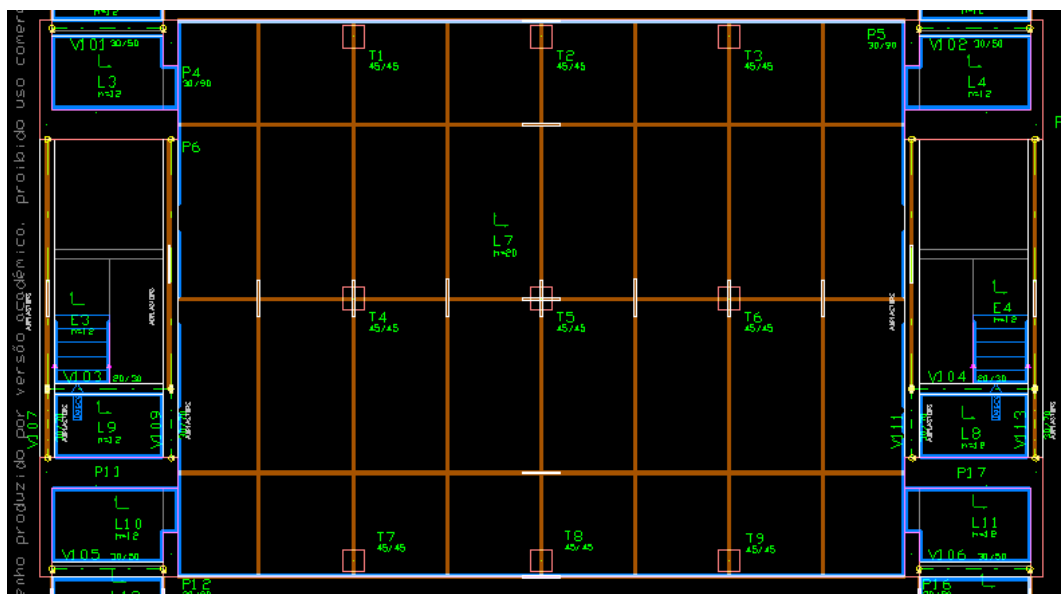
Cargas de alvenaria na laje principal do pavimento
